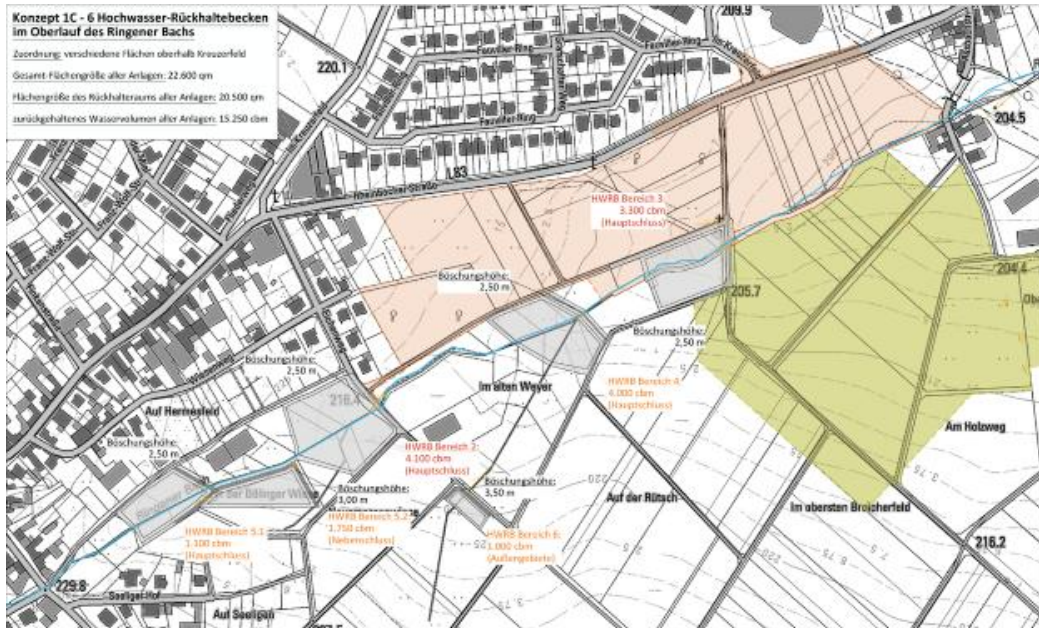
Geplante Beckenstandort, Ingenieurgruppe Steen-Meyers-Schmidem
